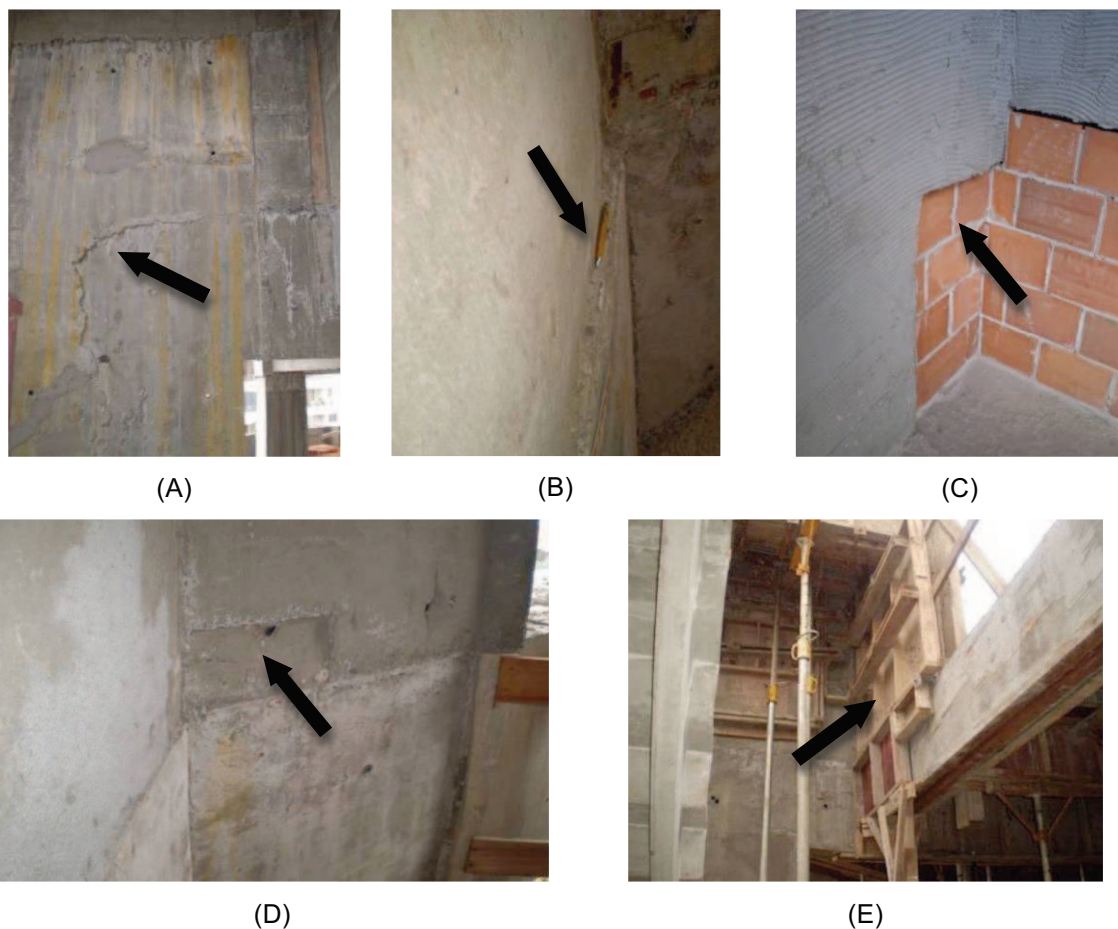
(A) Falhas na concretagem. (B) Desnível na face do Pilar. (C) Falha na locação. (D) Falha na face do Pilar. (E) Montagem Fôrmas.
